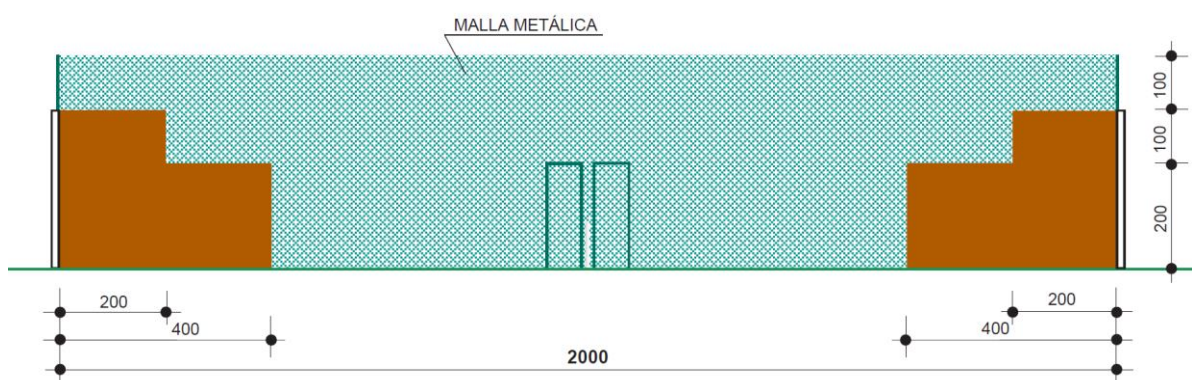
Alzado lateral, pista de pádel (variante 2).
